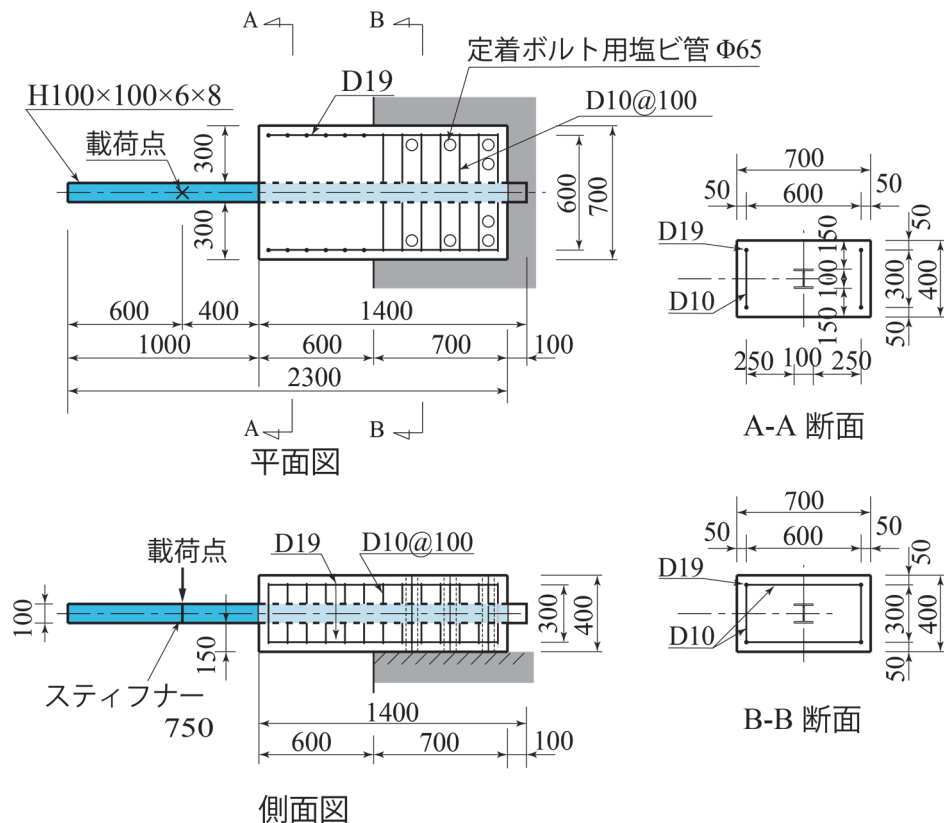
試験体の断面寸法，支柱模型の設置位置，鉄筋の配筋状況
